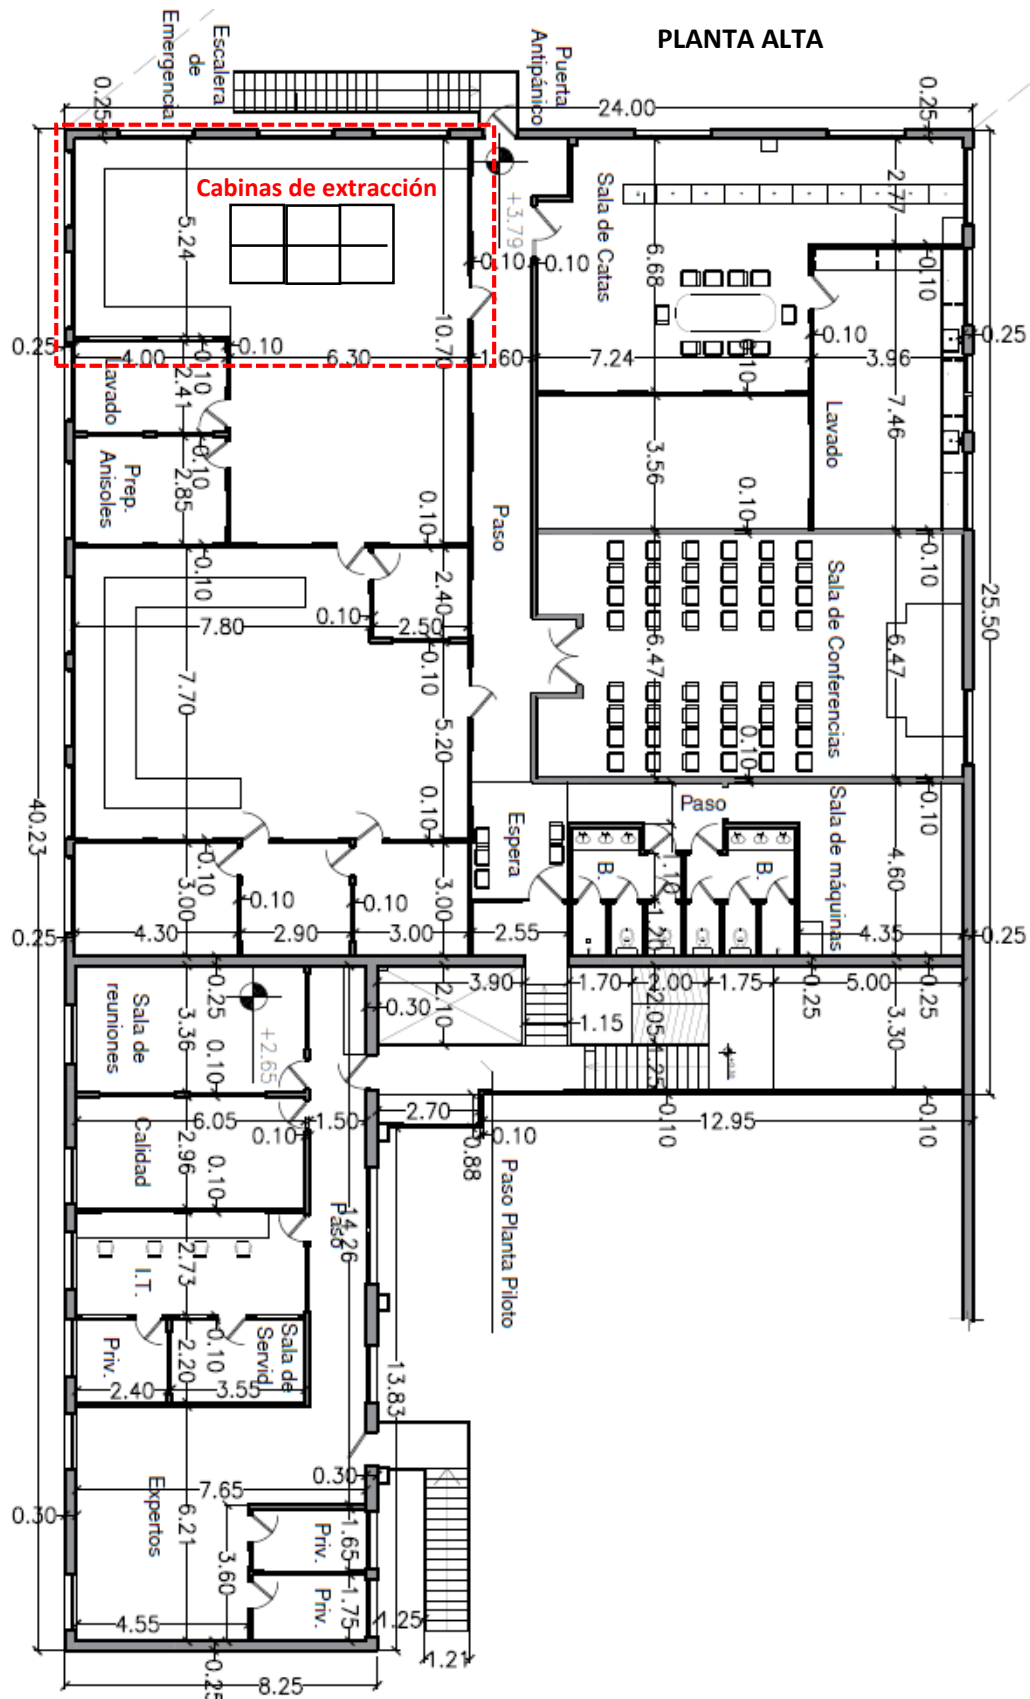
Plano sede Villa Regina planta alta – sectorización cabinas de extracción
